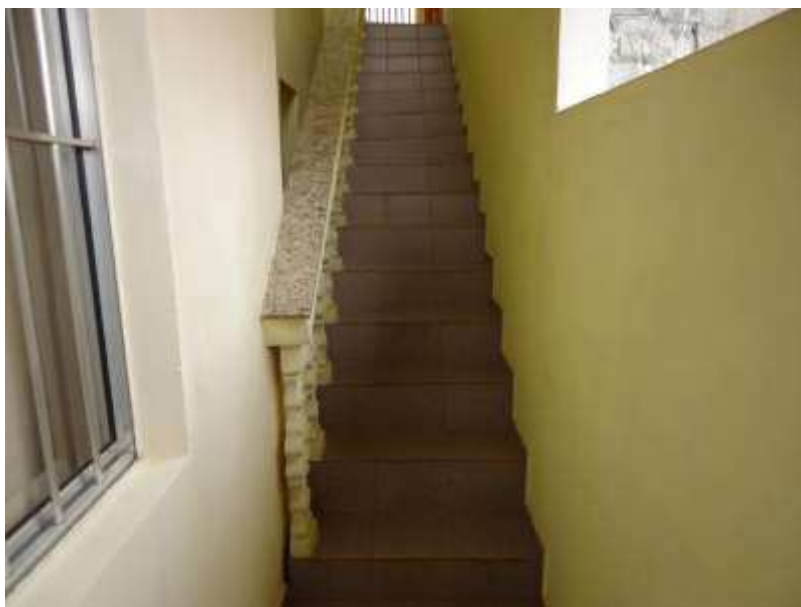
Detalhe externo da edificação – Escada Pav. Térreo p/ Pav. Inferior
